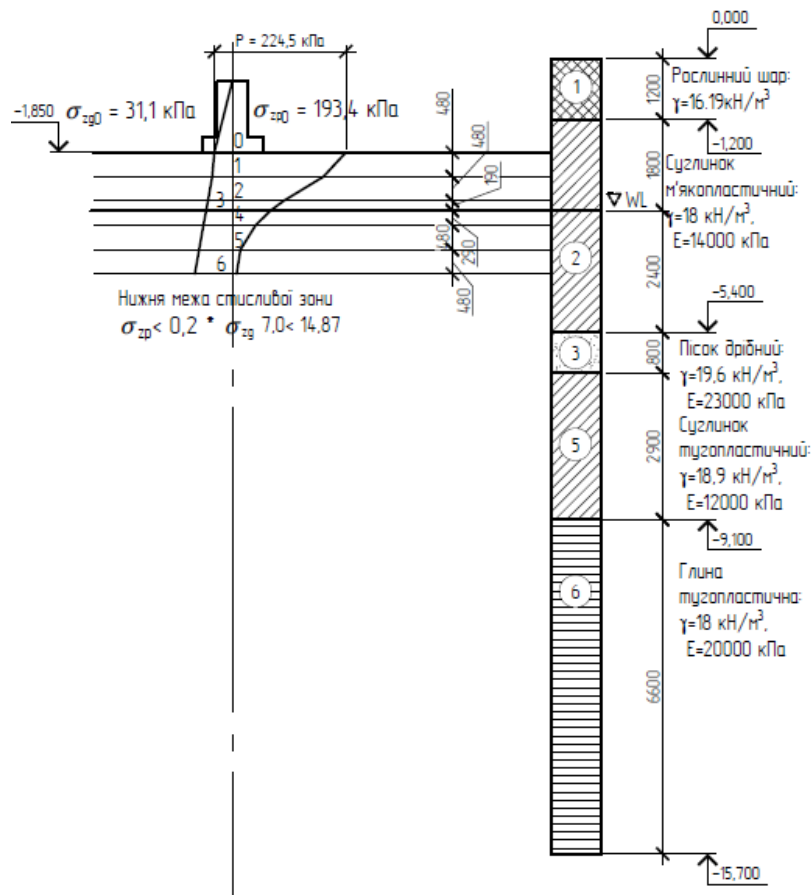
Розрахункова схема осідання фундаменту ФМ-1.
